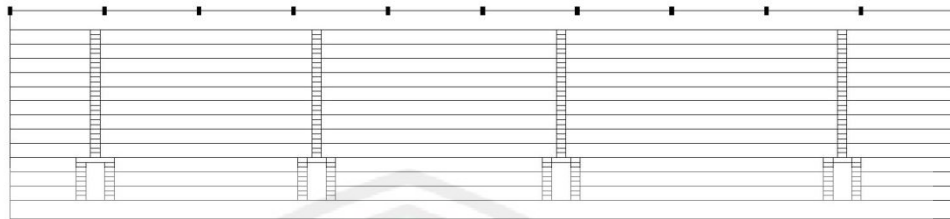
Denah lantai 2 Stadion Sepakbola Pantai
